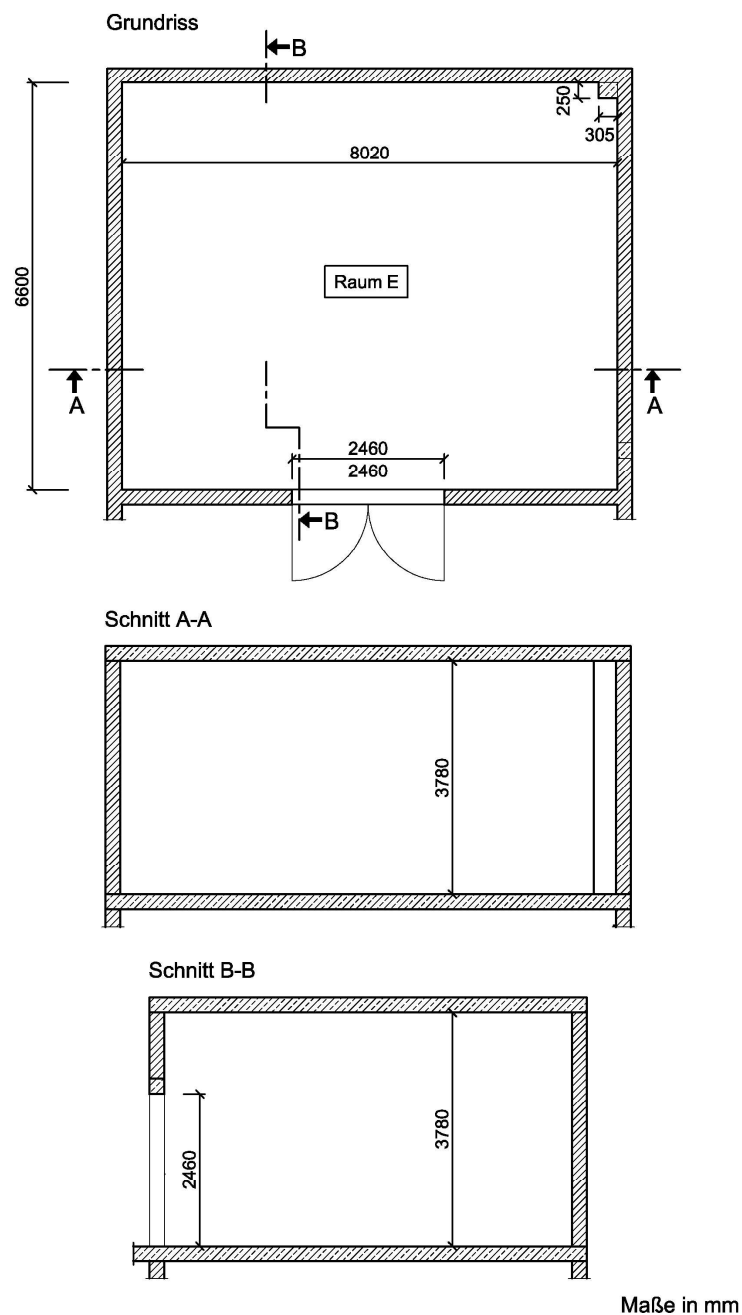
Grundriss und Schnitte des Hallraums.
